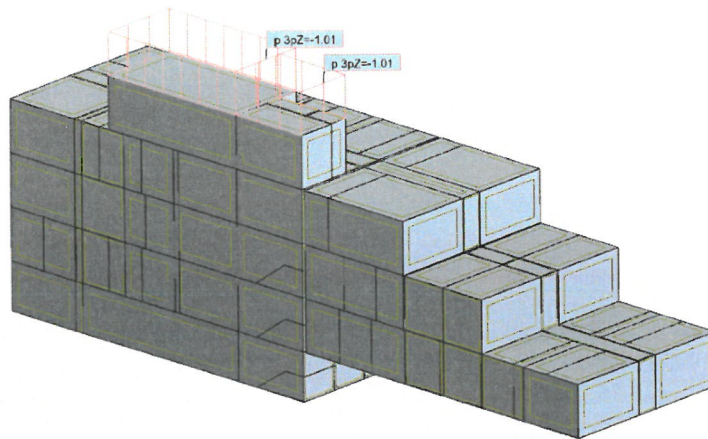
Przypadek obciążenia stałego od dachu ekstensywnego
